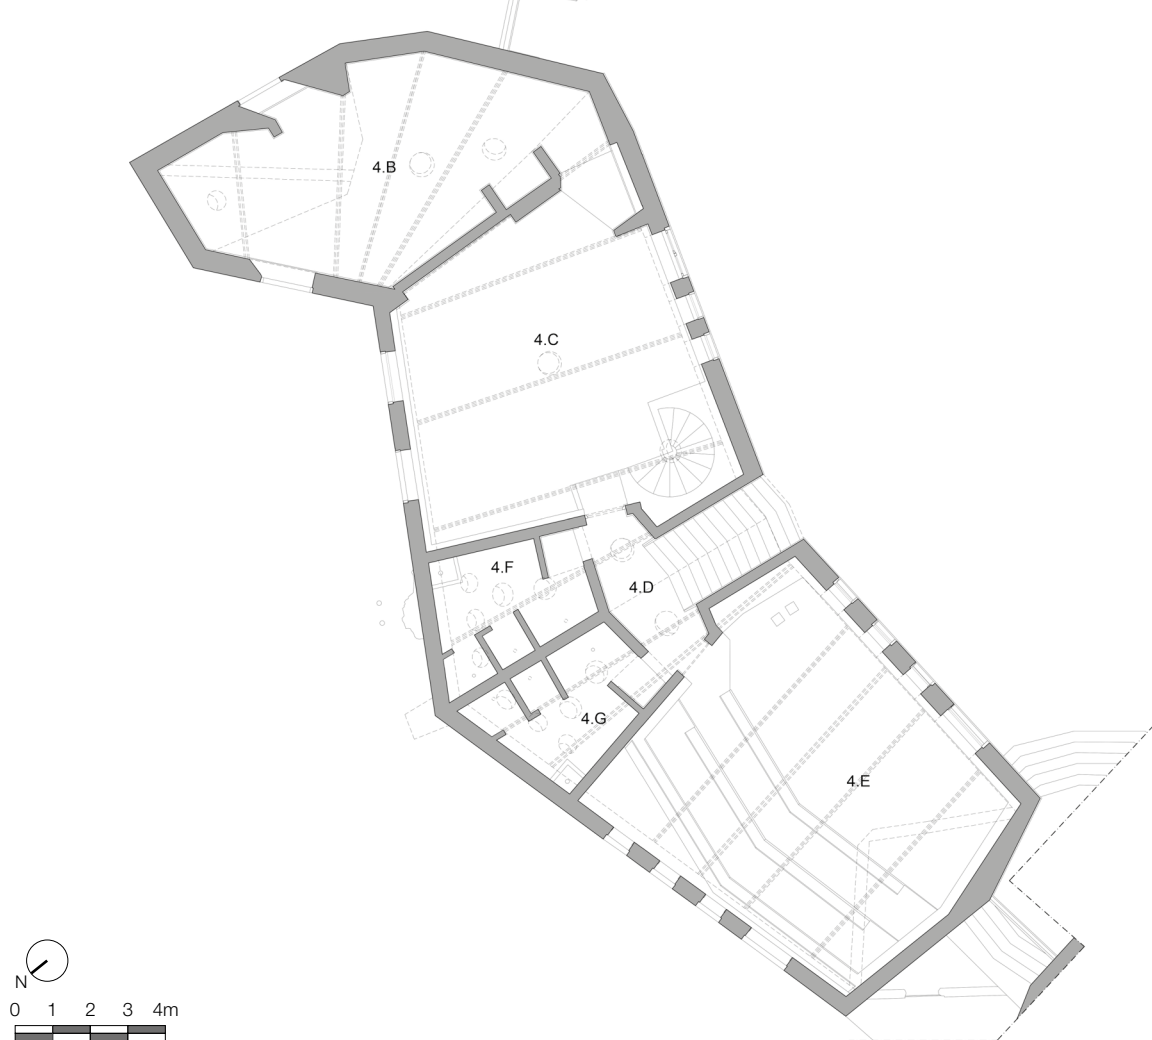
| Planta del bloque 4 (escala original de representación 1:50). | Pianta del blocco 4 (scala originaria di rappresentazione 1:50).
